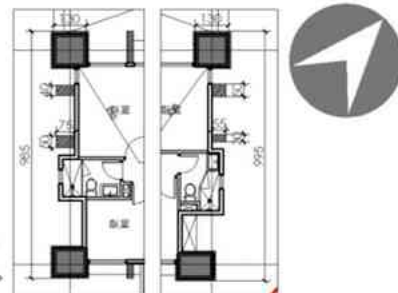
10F 平面圖；SCALE A3=1/300
